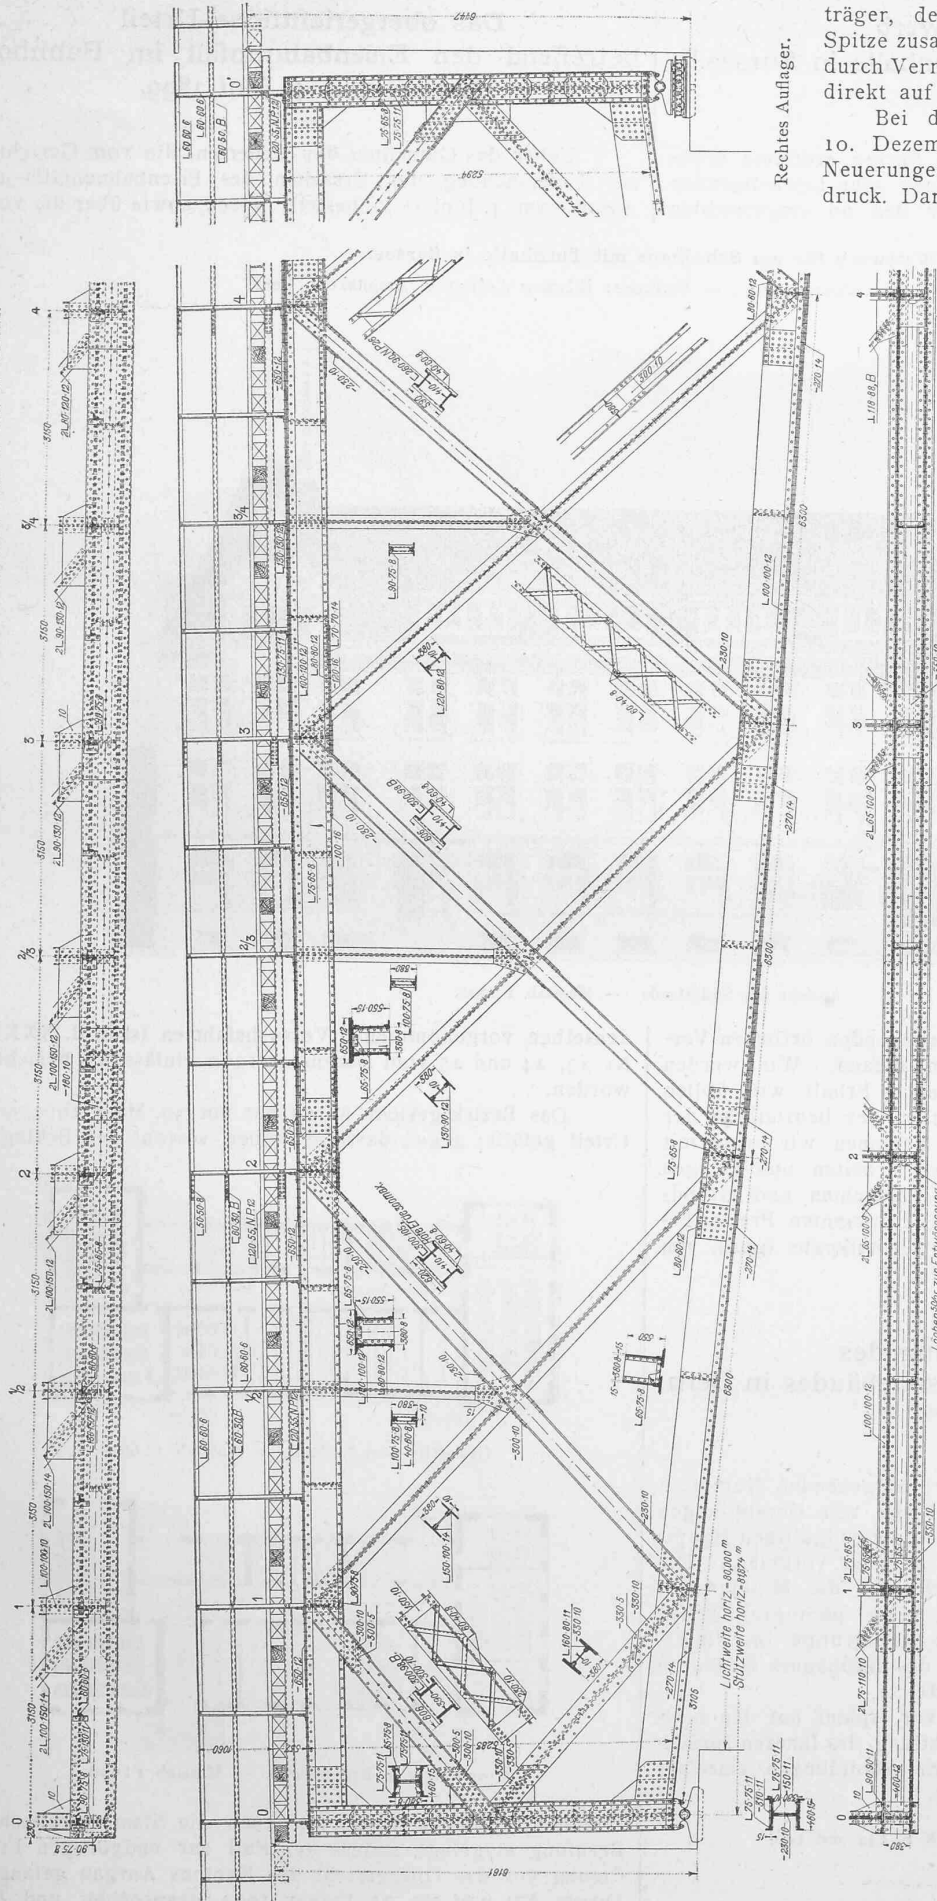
Seitenansicht des Fachwerks. — Masstab 1:100.
